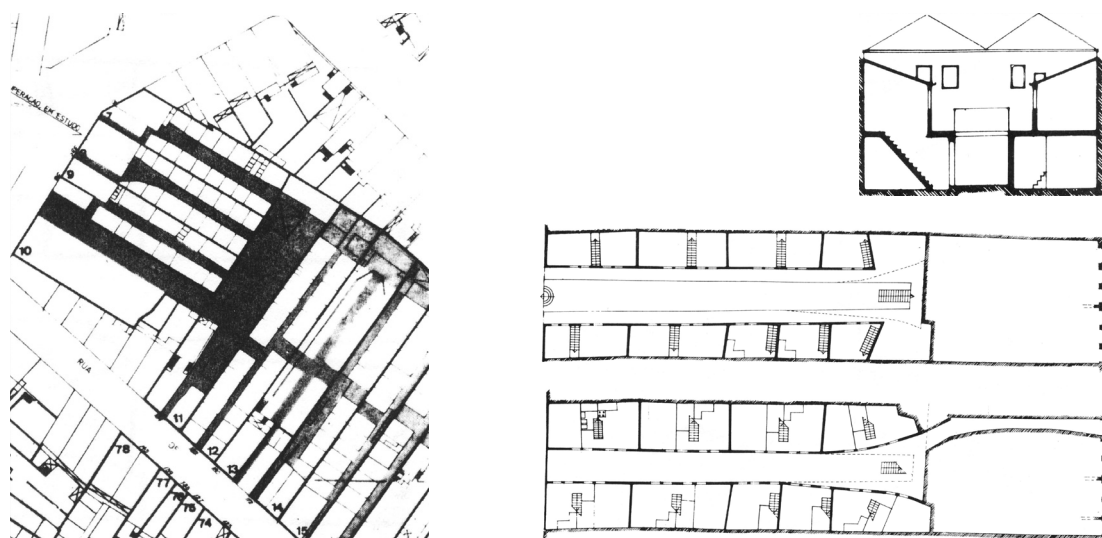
Plano geral do sector de S. Vítor e projecto de recuperação de uma ilha, plantas e corte.
